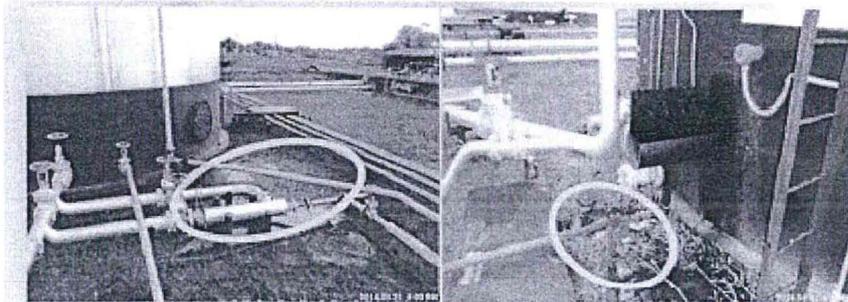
E: 0493261 N: 9578483 / Tanque de Lavado (Gun Barrel) en Batería 1.
